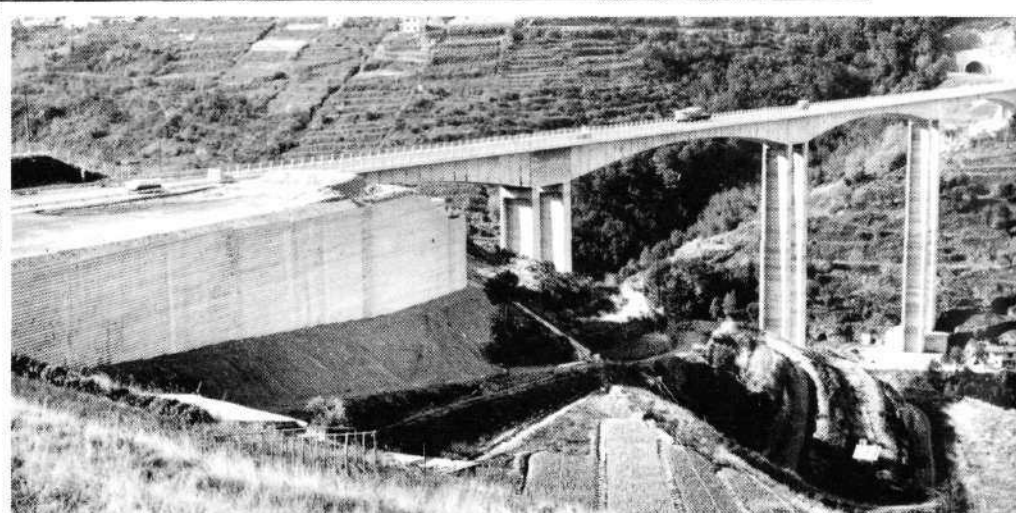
Culée de Freyning sur l'autoroute A34 Metz-Strasbourg
